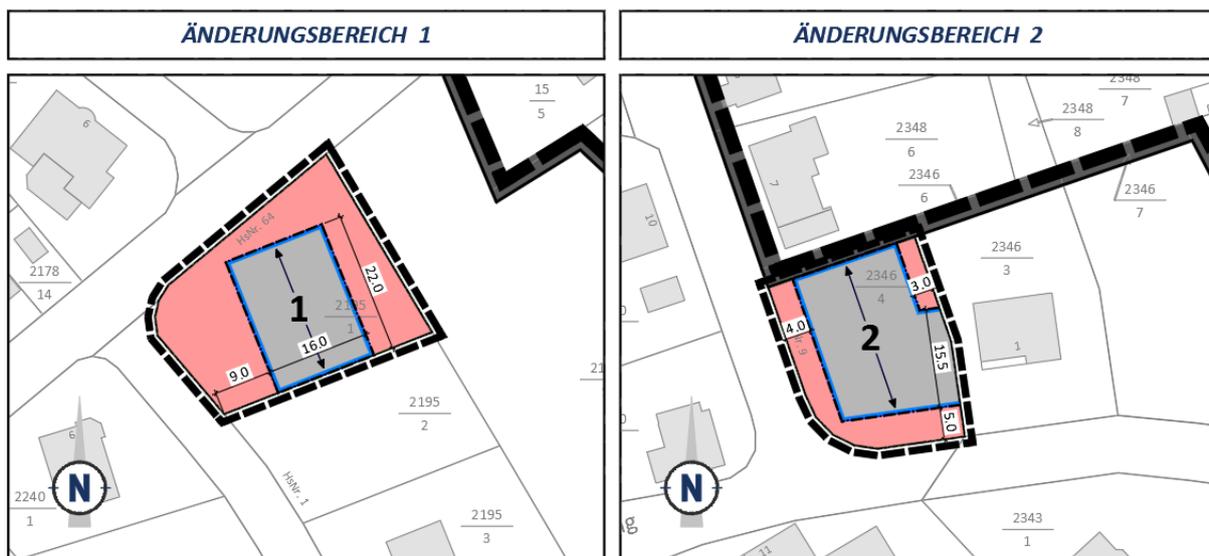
Änderungsbereiche des Bebauungsplans „Auf der Wurzel und im Flur“
